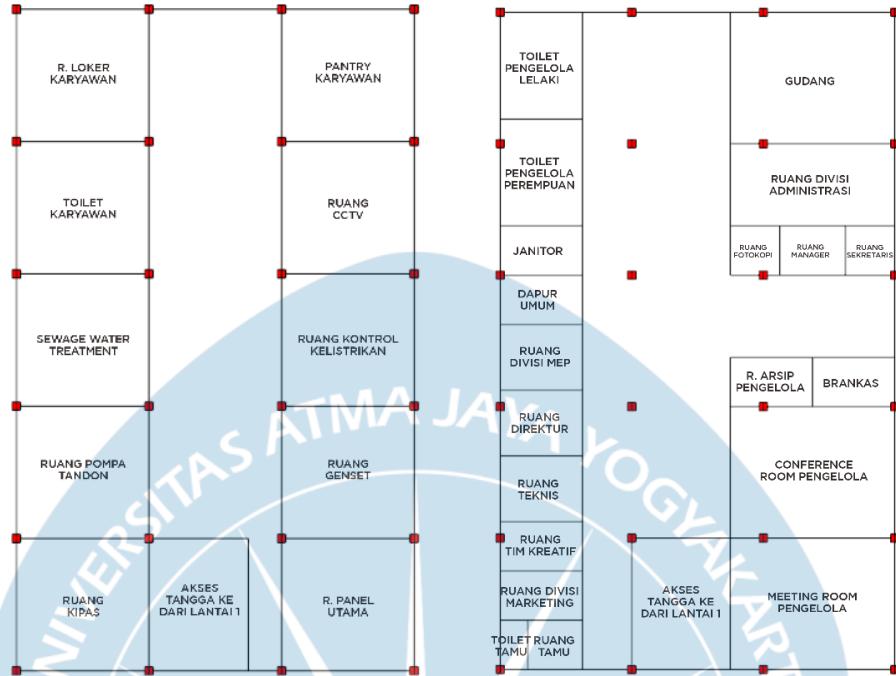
13 Rencana Blok Massa 1 Lantai 2
